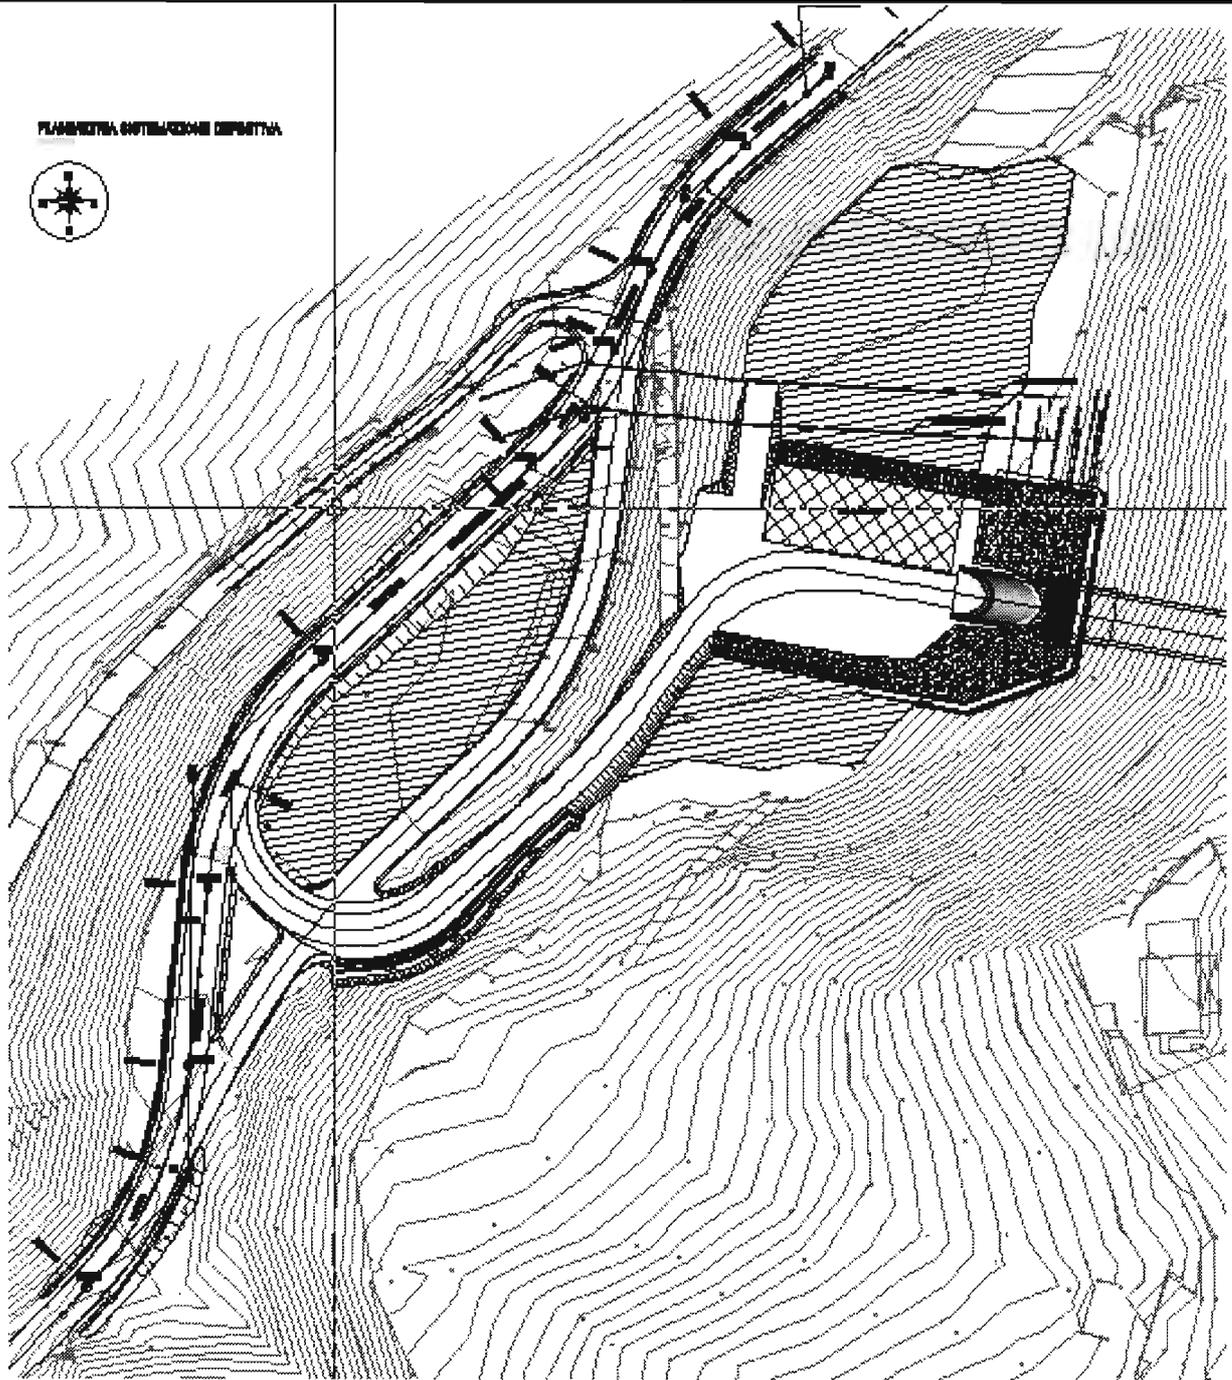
Planimetria viabilità Variante SS242 di Val Gardena
